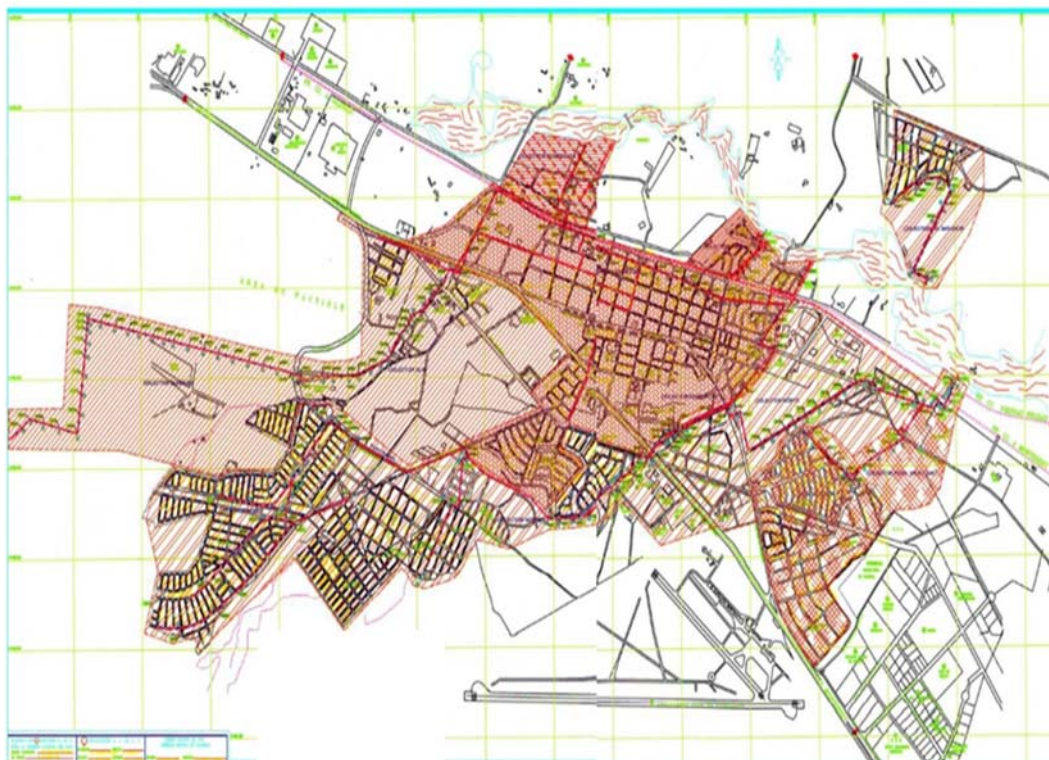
Plano General de Alcantarillado Sanitario de Ramos Arizpe en 2005
